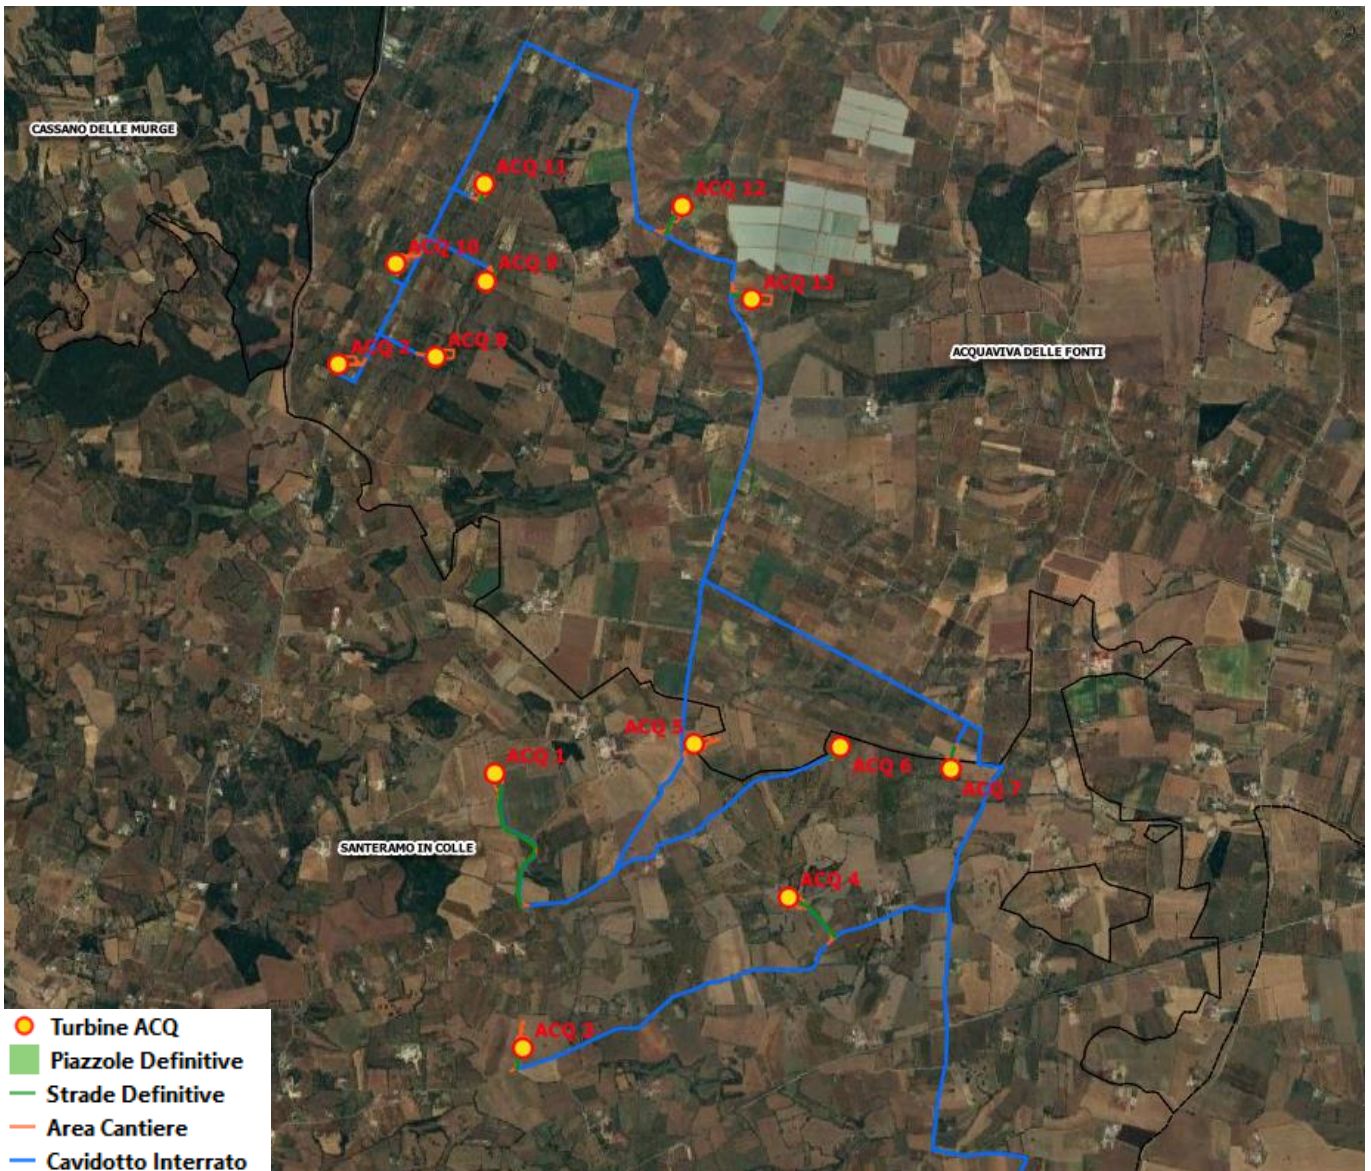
Area di intervento: layout di progetto su ortofoto – Area Turbine
